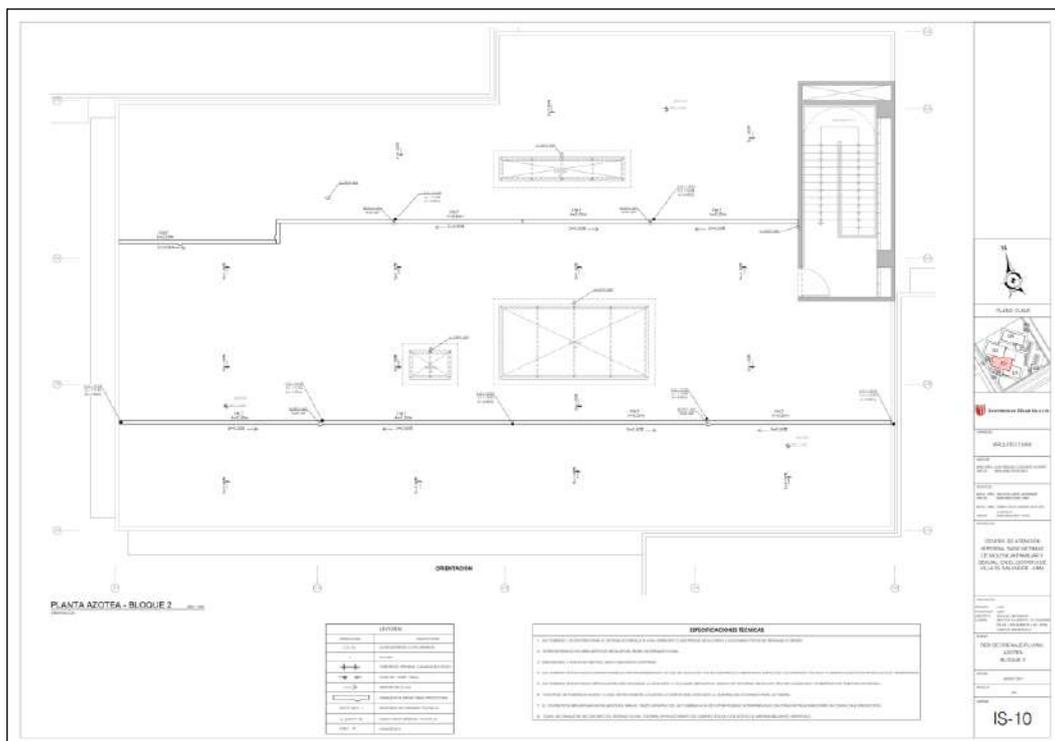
Planta azotea red de drenaje pluvial – bloque 2.
